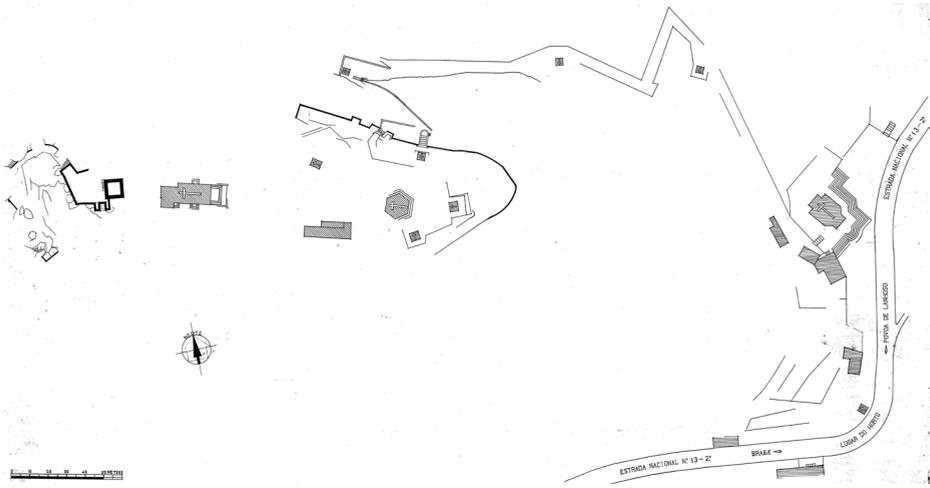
Castelo de Lanhoso, planta, antes das obras
